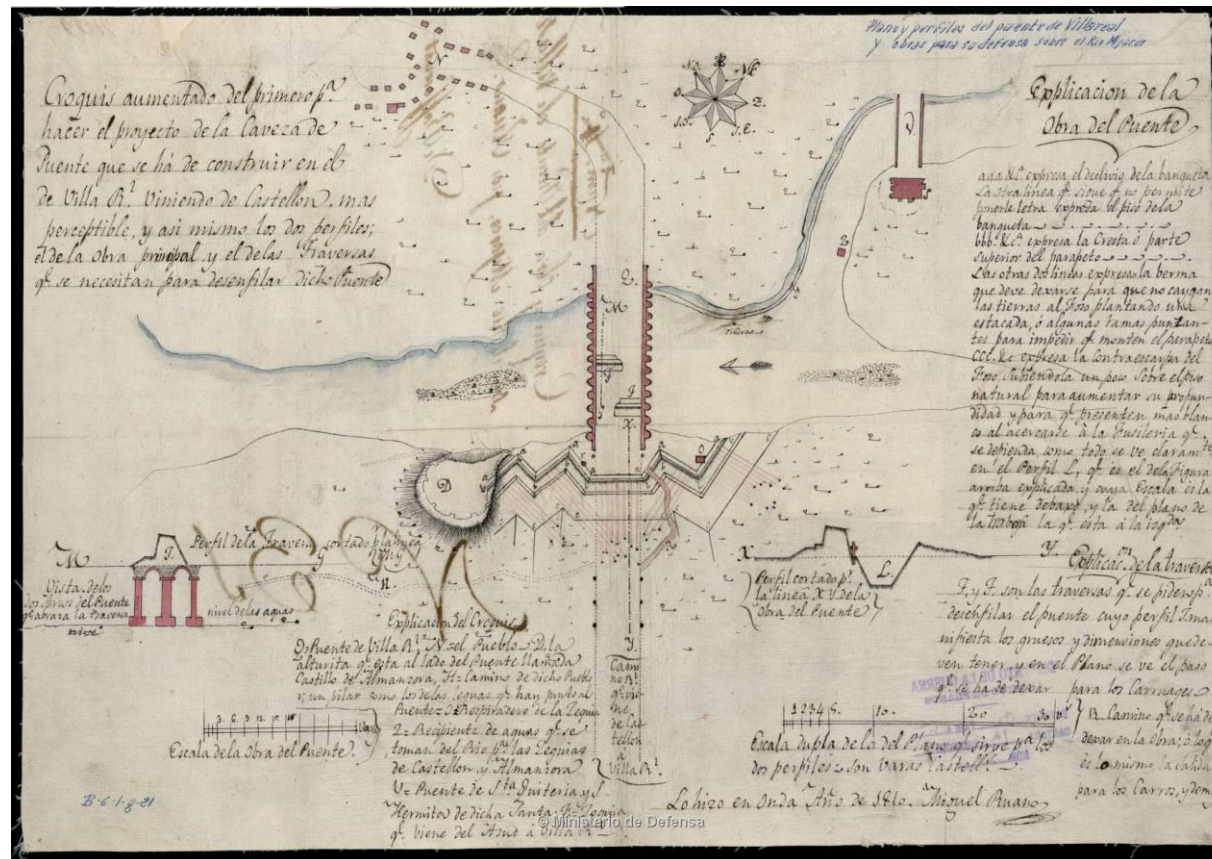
Croquis y plano de las obras de defensa construidas en Villareal y el río Mijares. Plano de 1810, que realizó Miguel Ruano en Onda.
